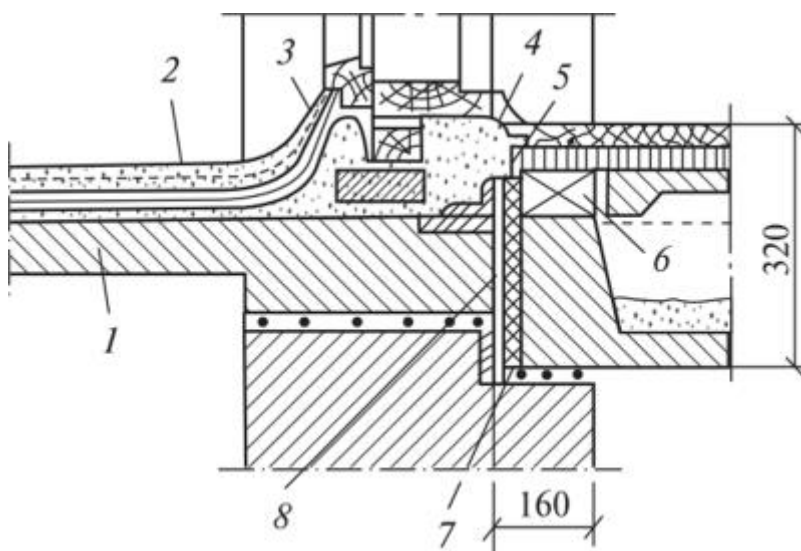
Сопряжение балконной плиты с наружной стеной:
